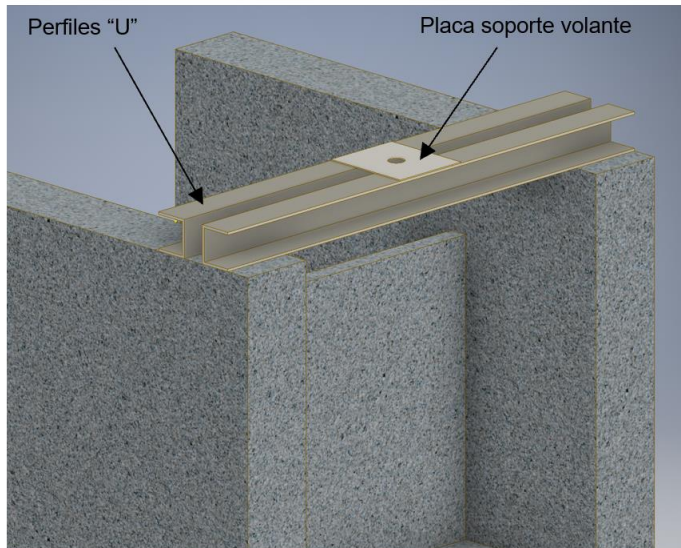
Puente de accionamiento (Fuente: Elaboración propia)
